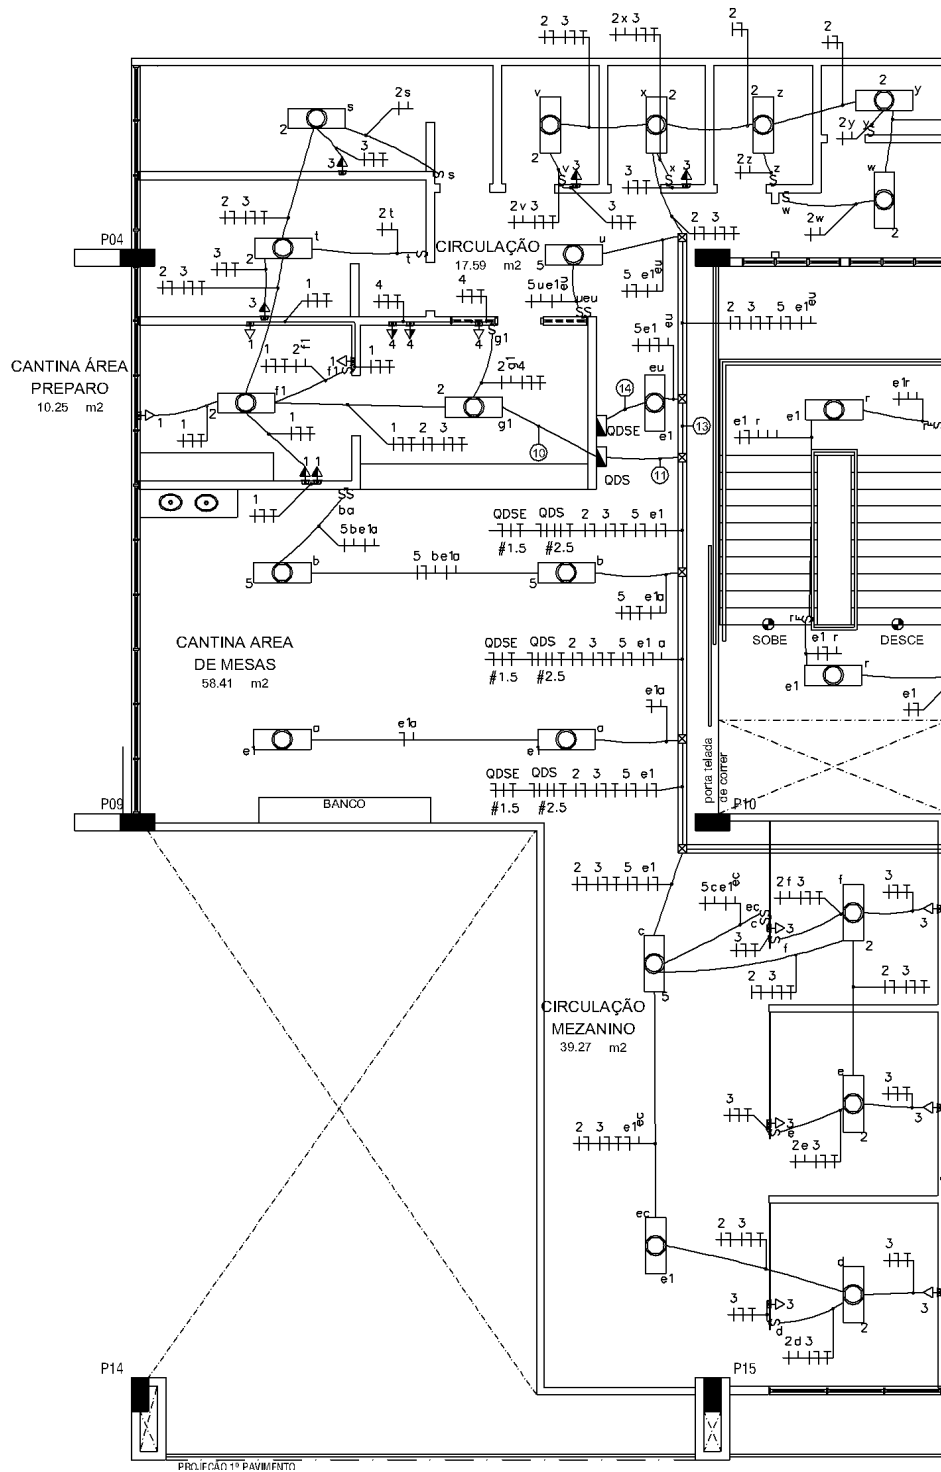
Planta baixa projeto elétrico do 2º pavimento do ICS (Continuação)
